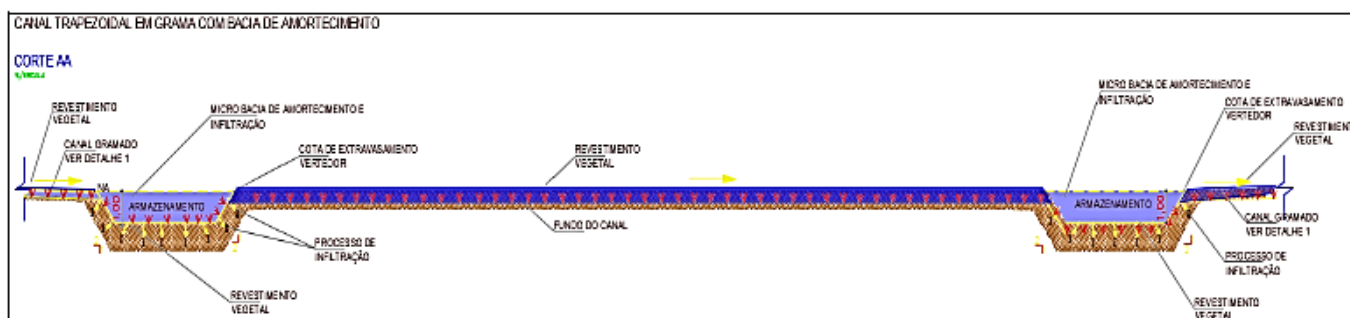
Canal Trapezoidal em grama com bacia de amortecimento.
